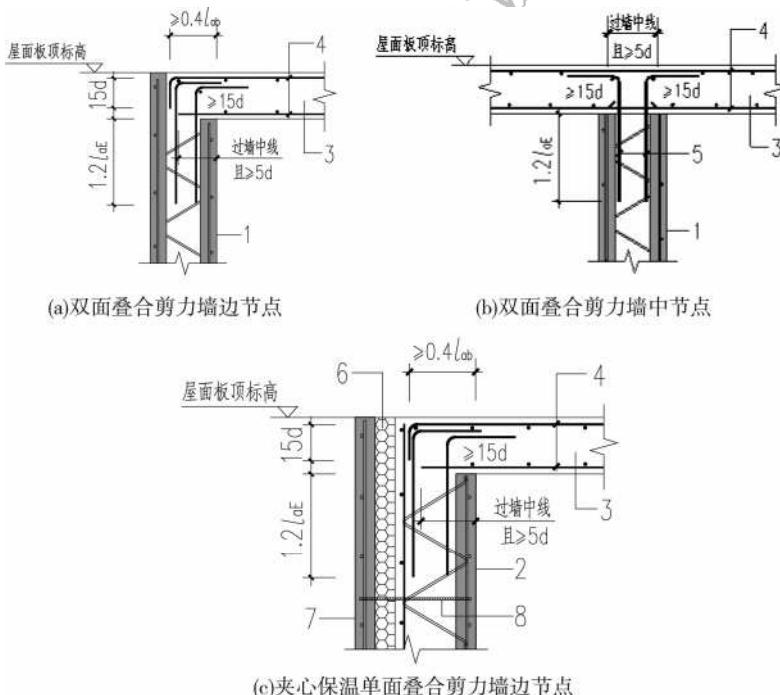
顶层现浇楼板与叠合剪力墙相连支座构造示意
